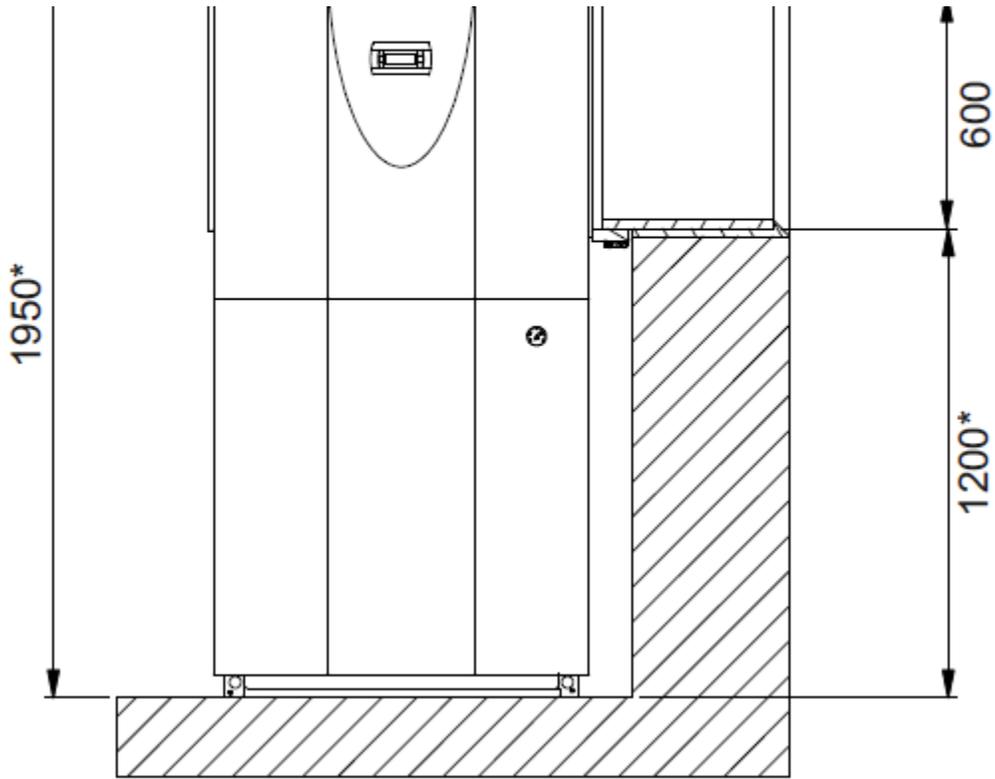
Vista frontale - LIK 12TU (installazione ad angolo)
